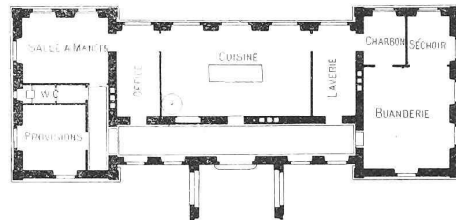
Hôpital communal à la Chaux-de-Fonds. — Plan du rez-de-chaussée. — Echelle 1 : 400.
